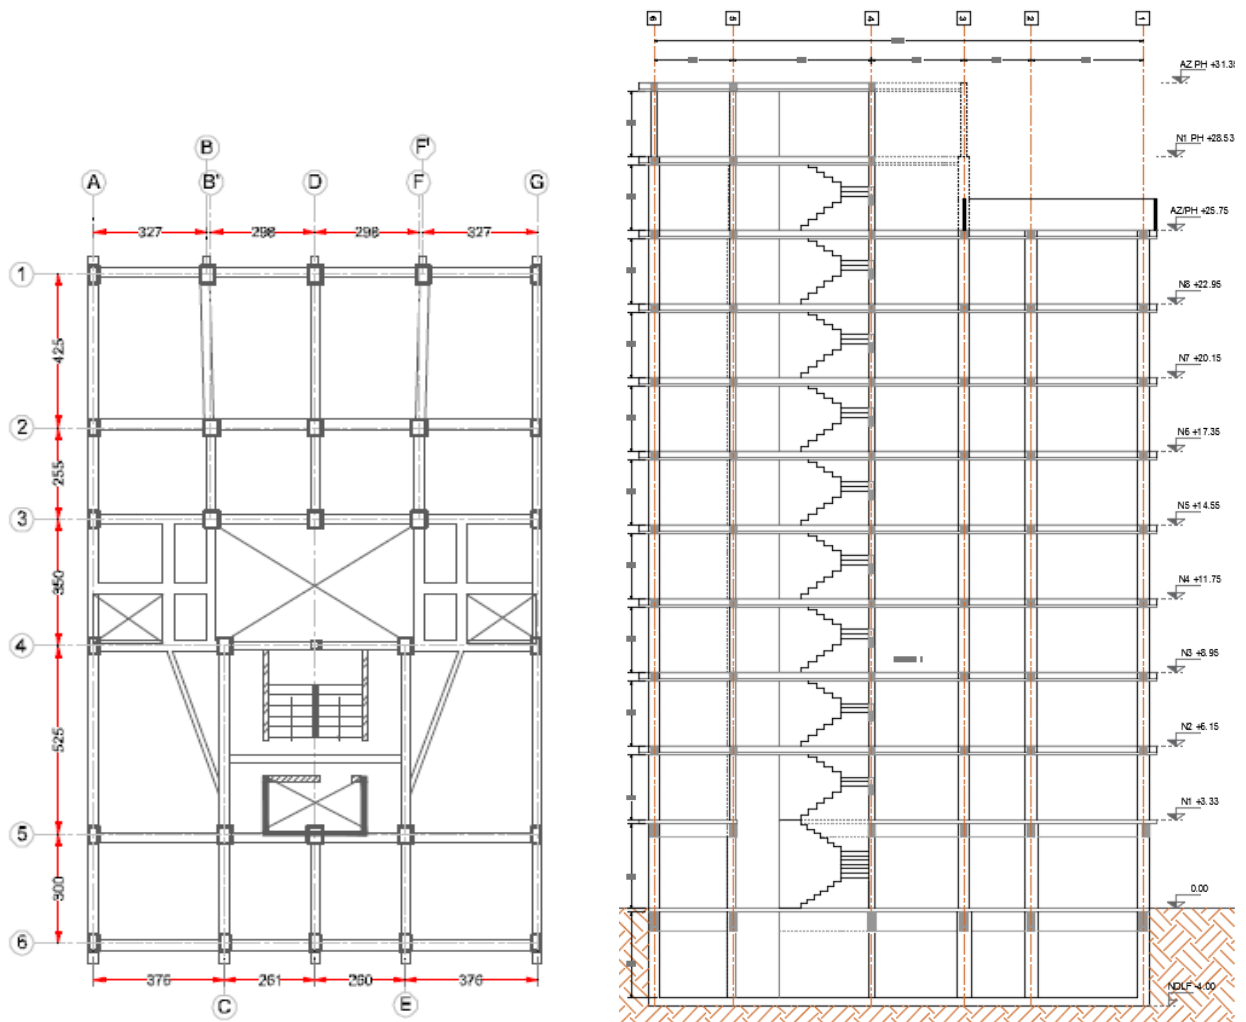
Planta tipo N1 a N8 y corte esquemático del edificio
